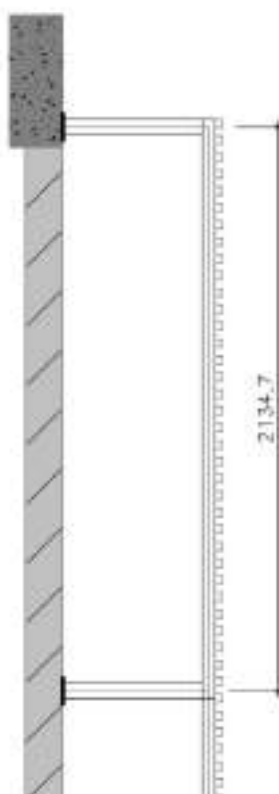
Vista Lateral – pórtico crítico suporte do brise
